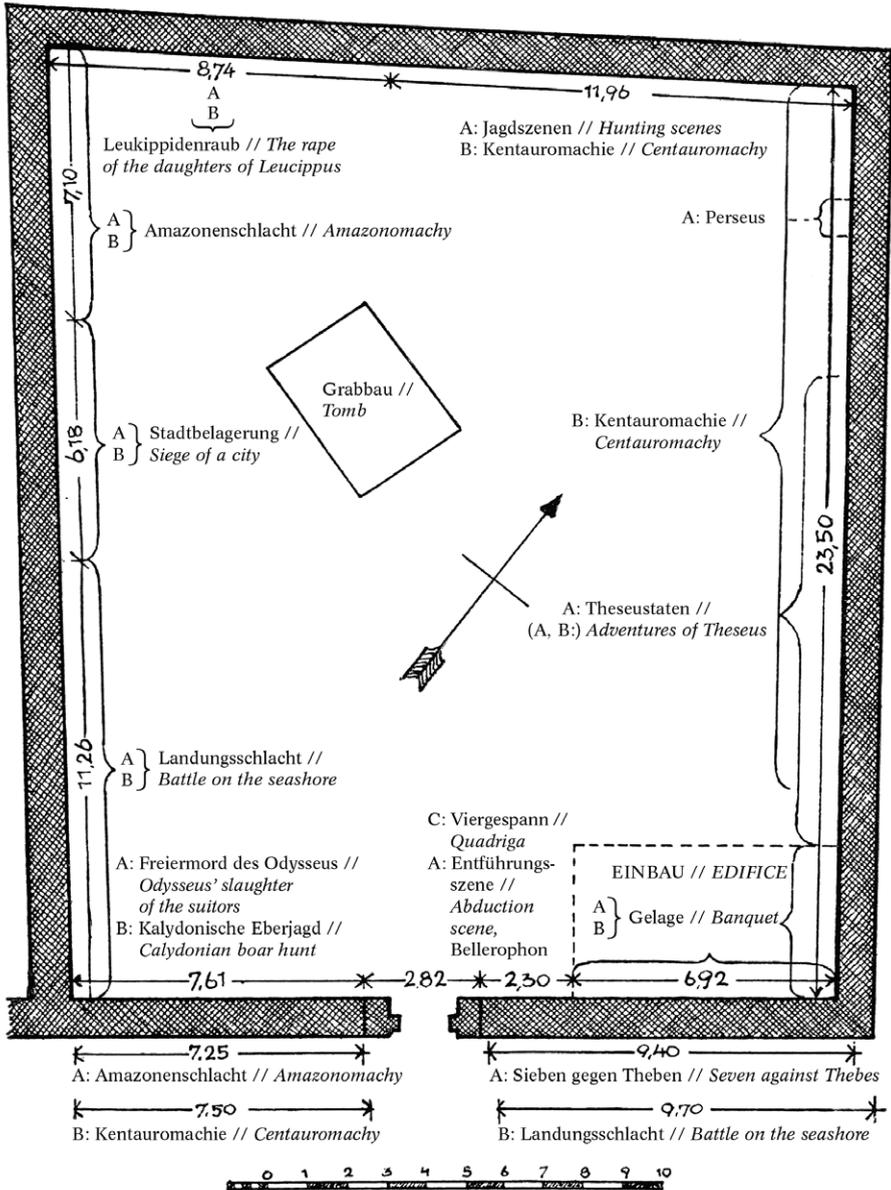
Trysa, Heron. Grundriss mit Übersicht der Bildthemen // Trysa, Heron. Ground plan with an overview of the frieze themes // Trysa, Heron. Pianta con prospetto dei temi dei fregi.
